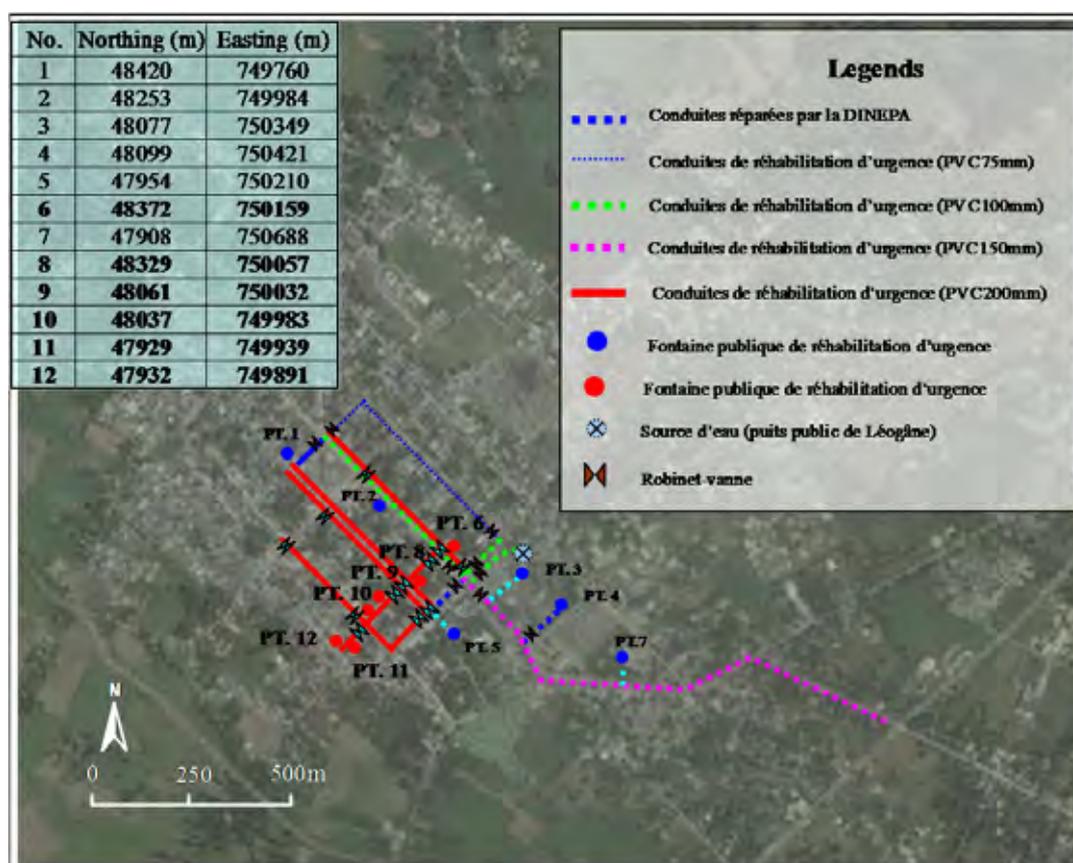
Plan de disposition des installations hydrauliques de la ville de Léogâne
